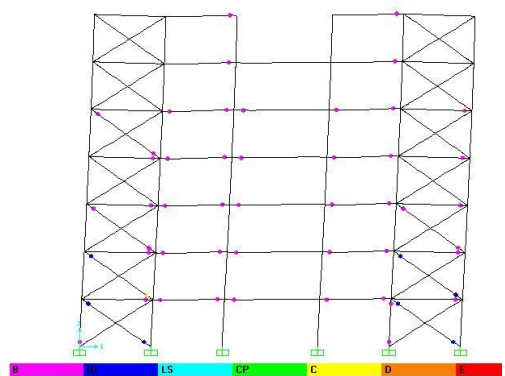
SRBE lantai 4 arah Y step 5 (Sumber Permodelan Sap2000)
